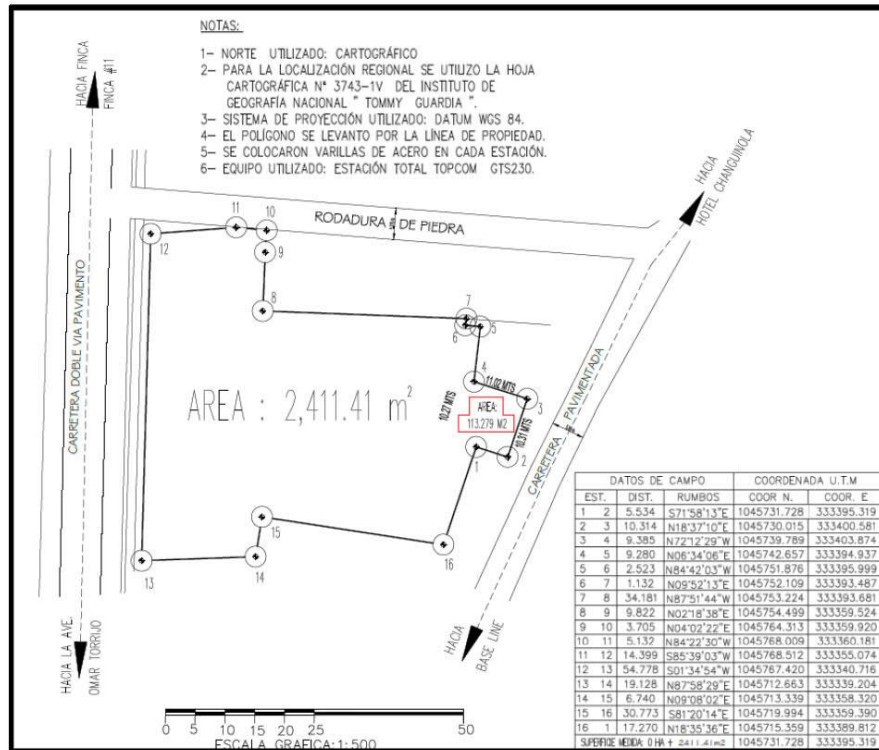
Esquema del polígono y coordenadas del proyecto. Fuente: Planos de ubicación.
